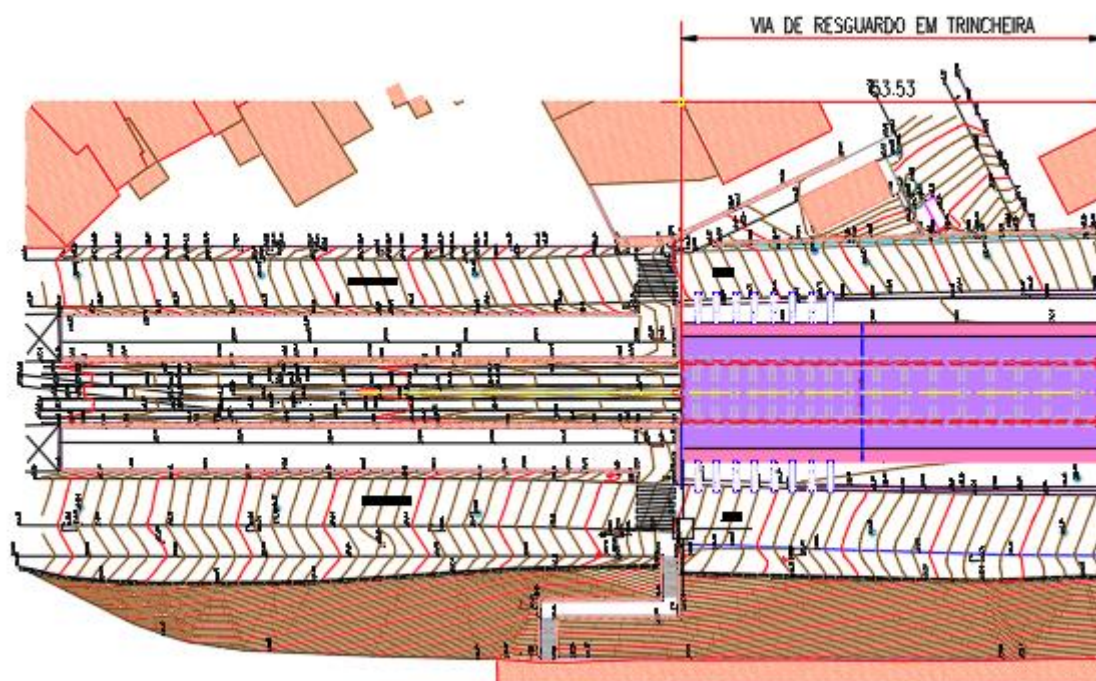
Planta ao nível do tabuleiro Via de Resguardo em Trincheira
